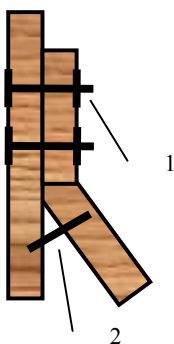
Кріплення розпірки до кріпіння балки
